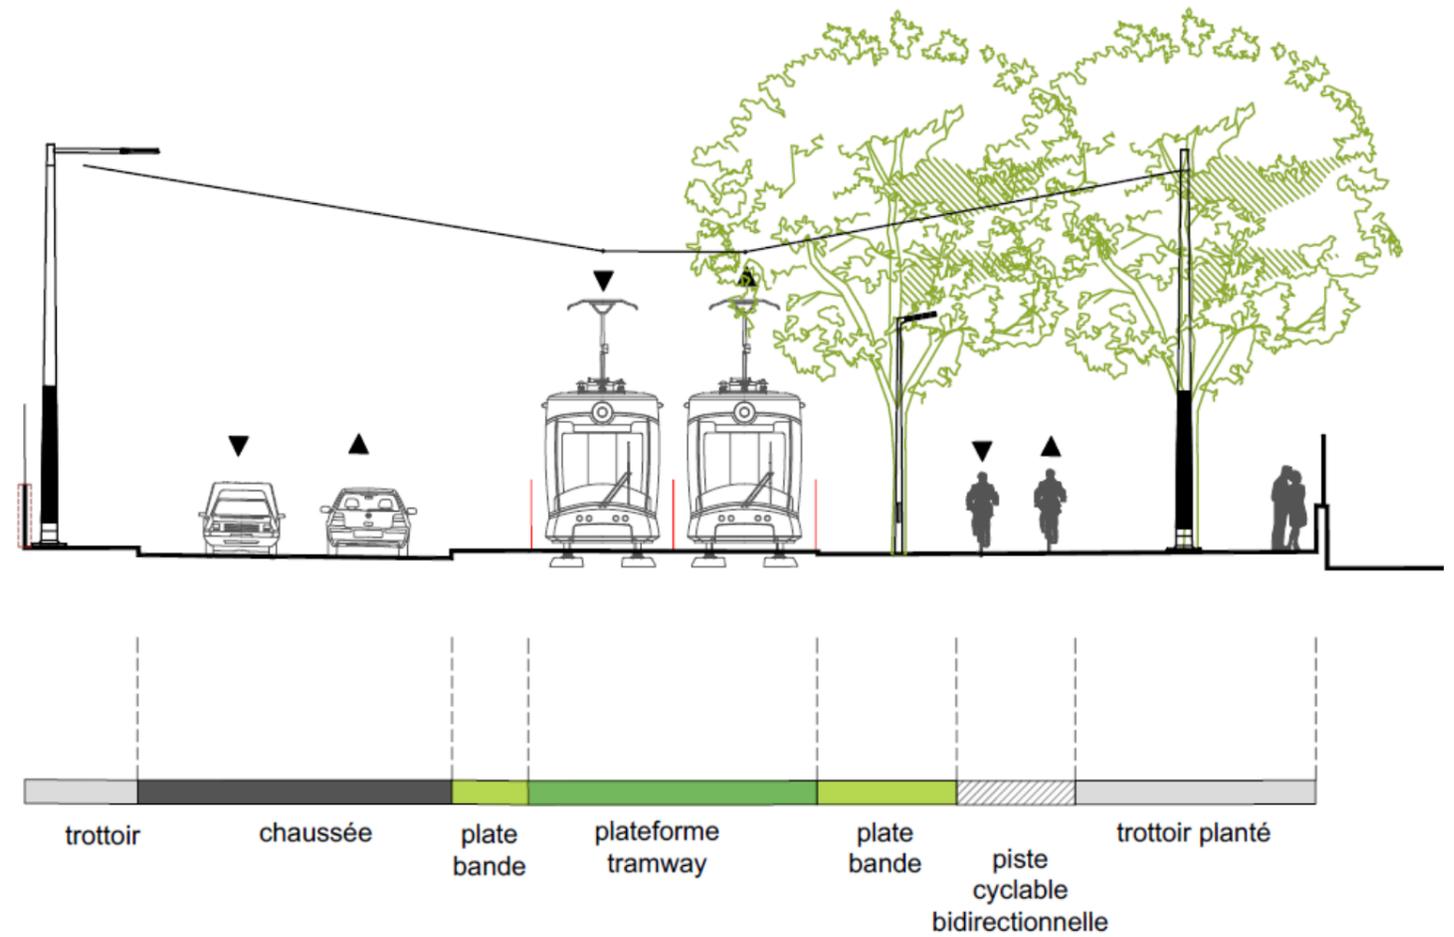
ci-contre : Exemple de profil en travers sur l'avenue Viton
